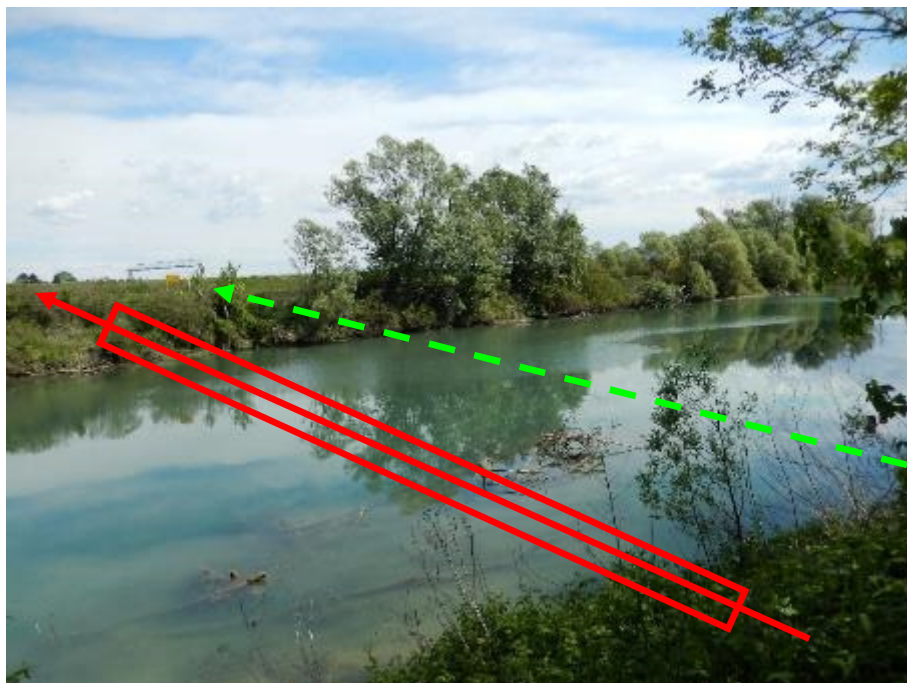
ATTRAVERSAMENTO FIUME PIAVE
